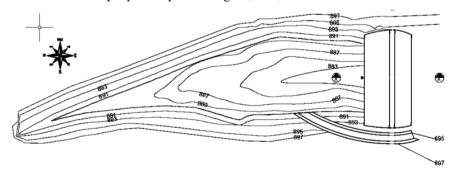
Local de escolha da barragem. Fonte: Autor.
